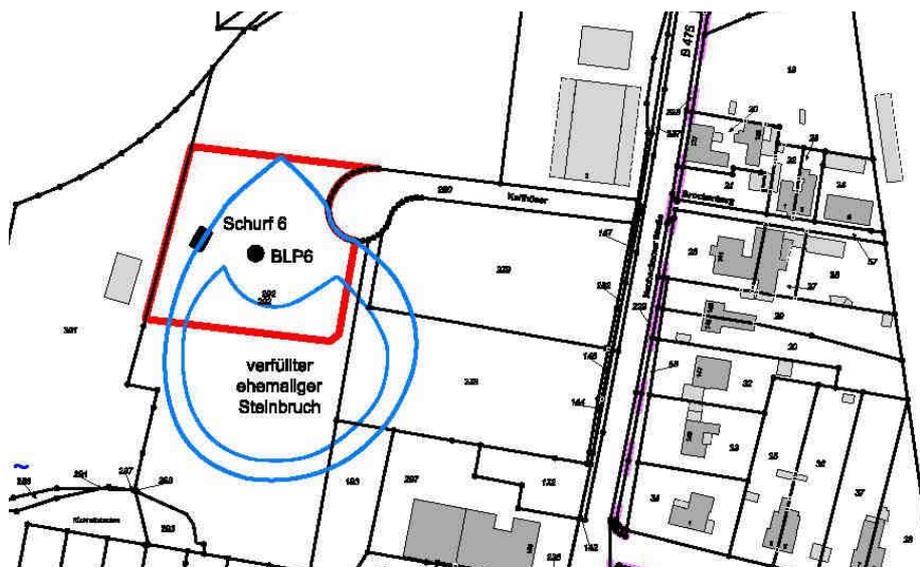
Lageplan mit ungefähre Lage des ehemaligen Steinbruchs (verfüllt), des Schurfes 6 und des BLP 6
